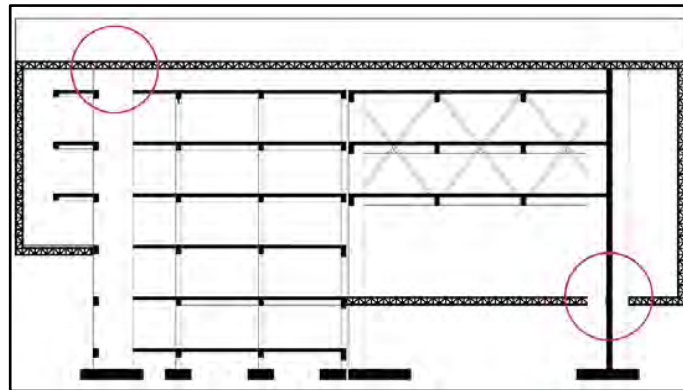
Detalle Estructural - Apoyo malla espacial en pantalla estructural
